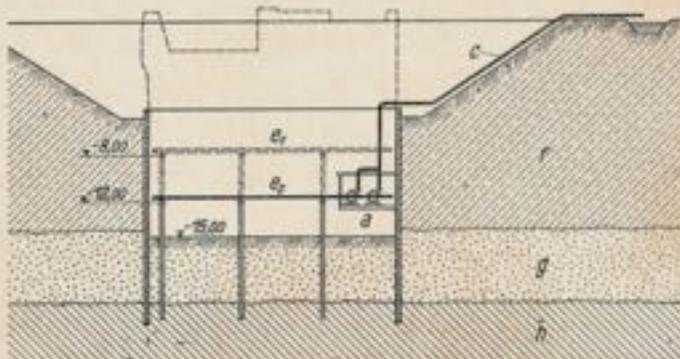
Plan de situation de l'installation de rabattement pour la fondation du pont tournant.
